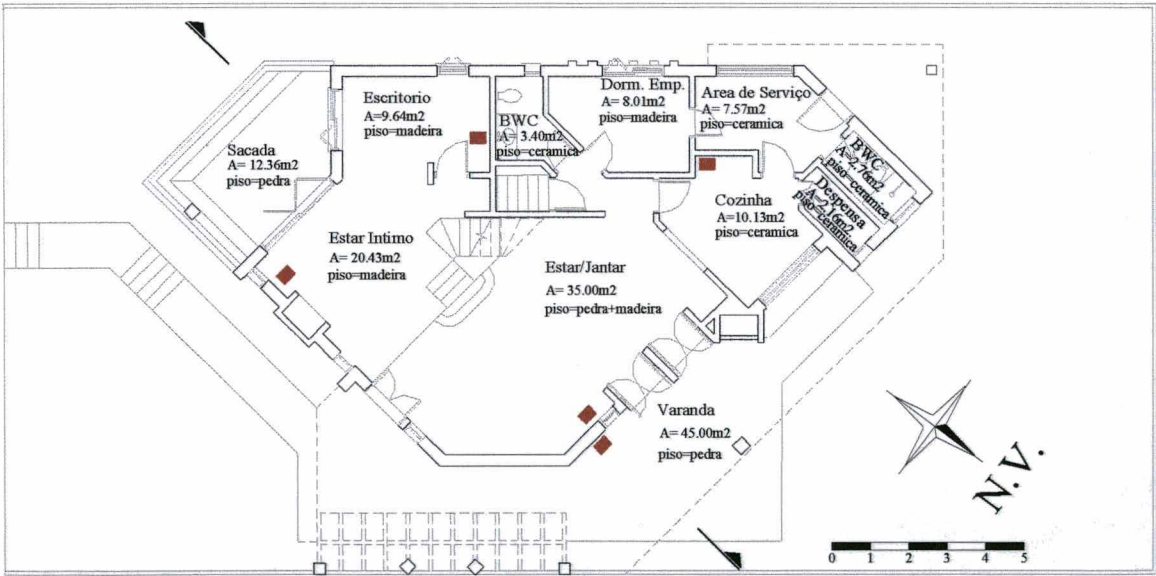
Planta Baixa Pavimento Térreo Residência 2
